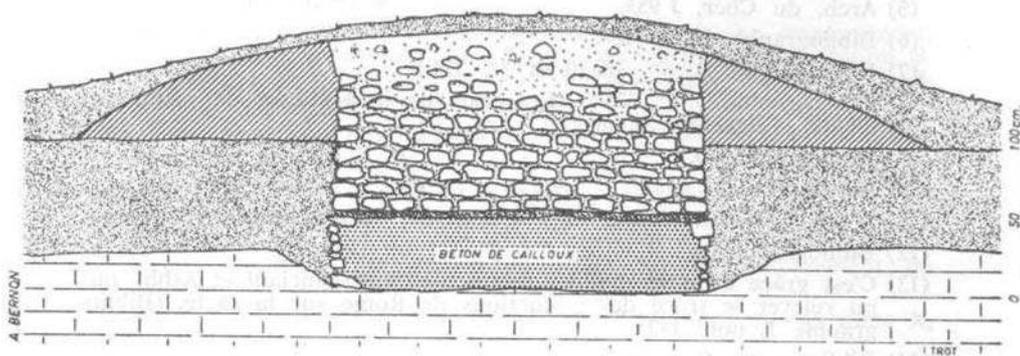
Coupe du mur des Bornigalles (BERNON et TROTIGNON 1979 : PL. V, Fig. 2).
